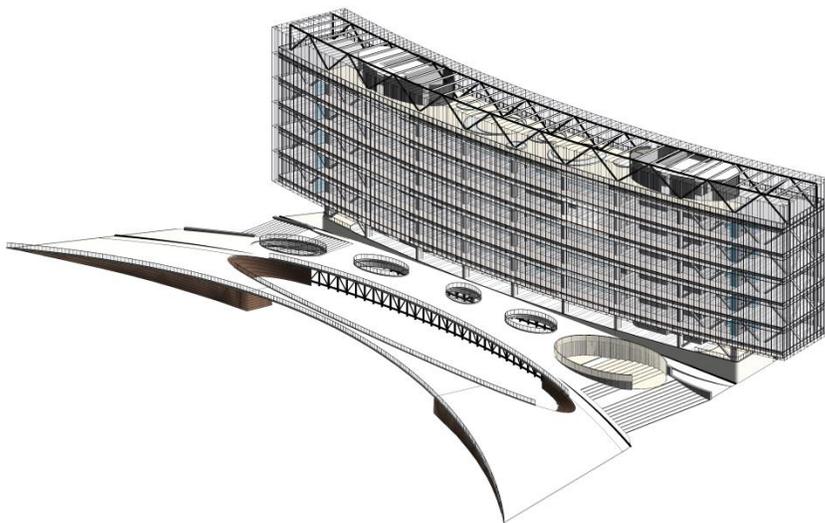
Proyecto arquitectónico CIED, primera fase
